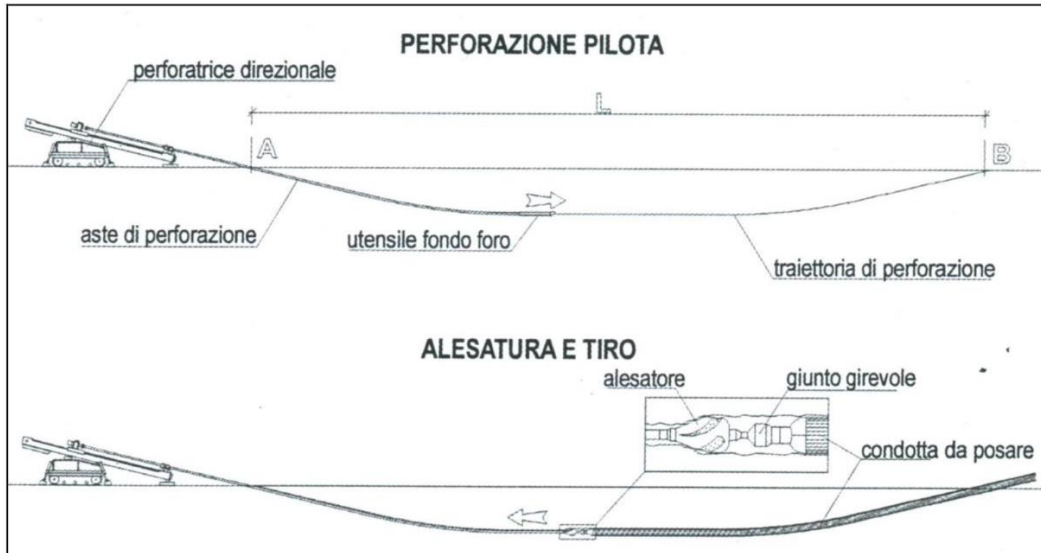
Sezione Tipo Attraversamento con foro pilota
